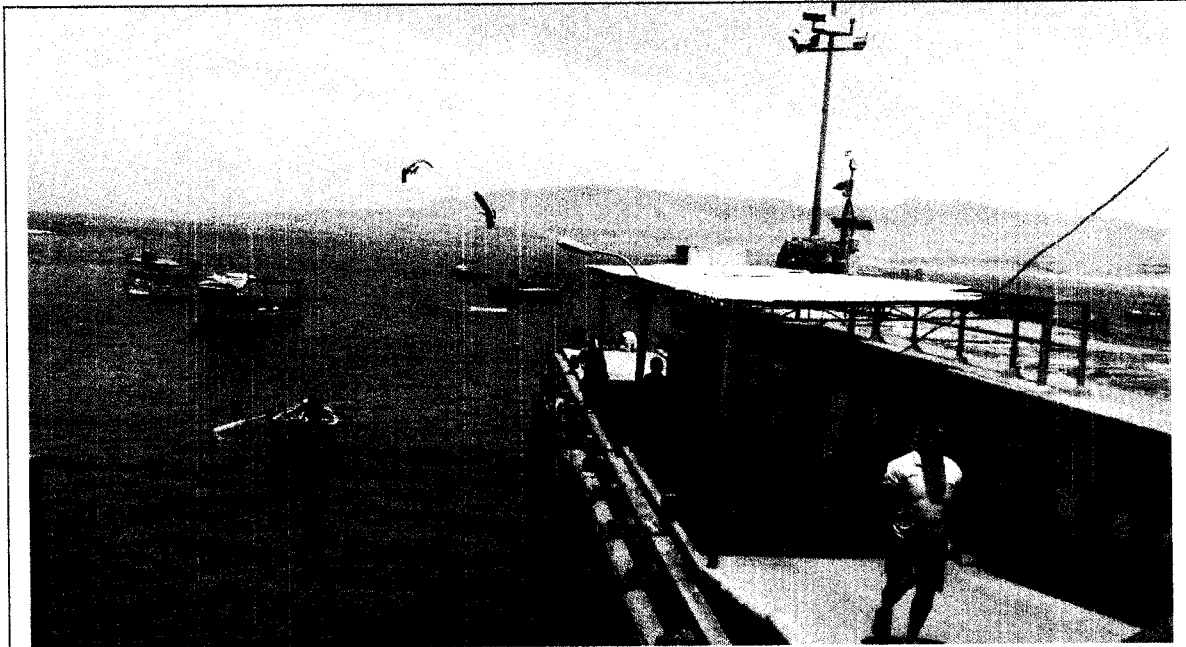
En la presente imagen se puede observar el mulle bajo la defensa de concreto inc. Llantas y coberturas con columnas y viguetas de acero, en los cuales se realizaran la reparación de defensa y cambio de estructuras metálicas y cobertura.
